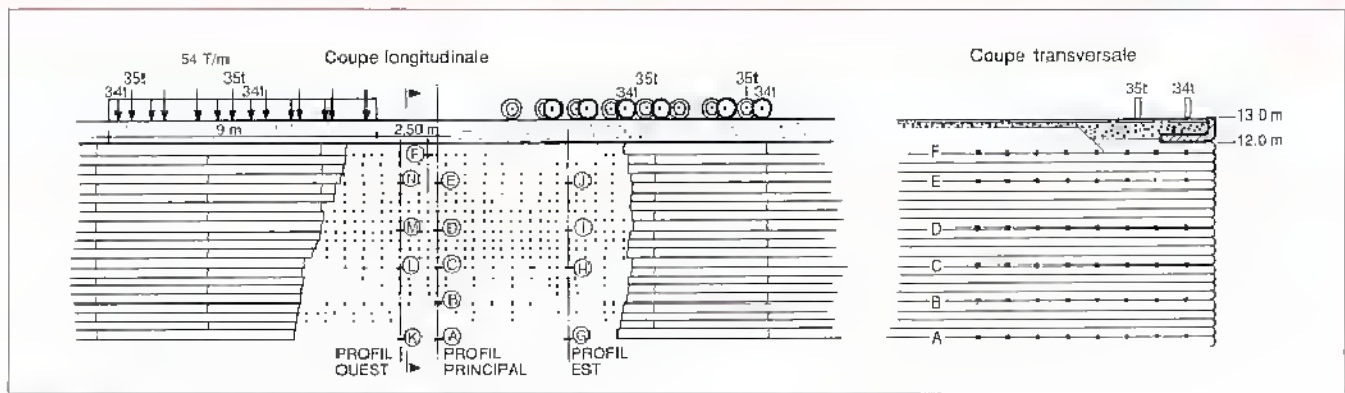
Ouvrage du port de Dunkerque. Profils de mesure.
